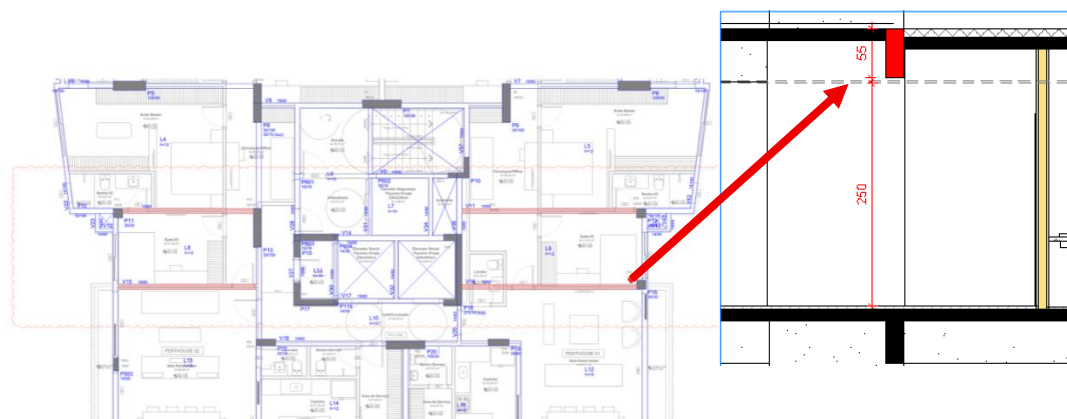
Interferência - Projeto de Arquitetura Executivo X Projeto Estrutural – AutoCAD
